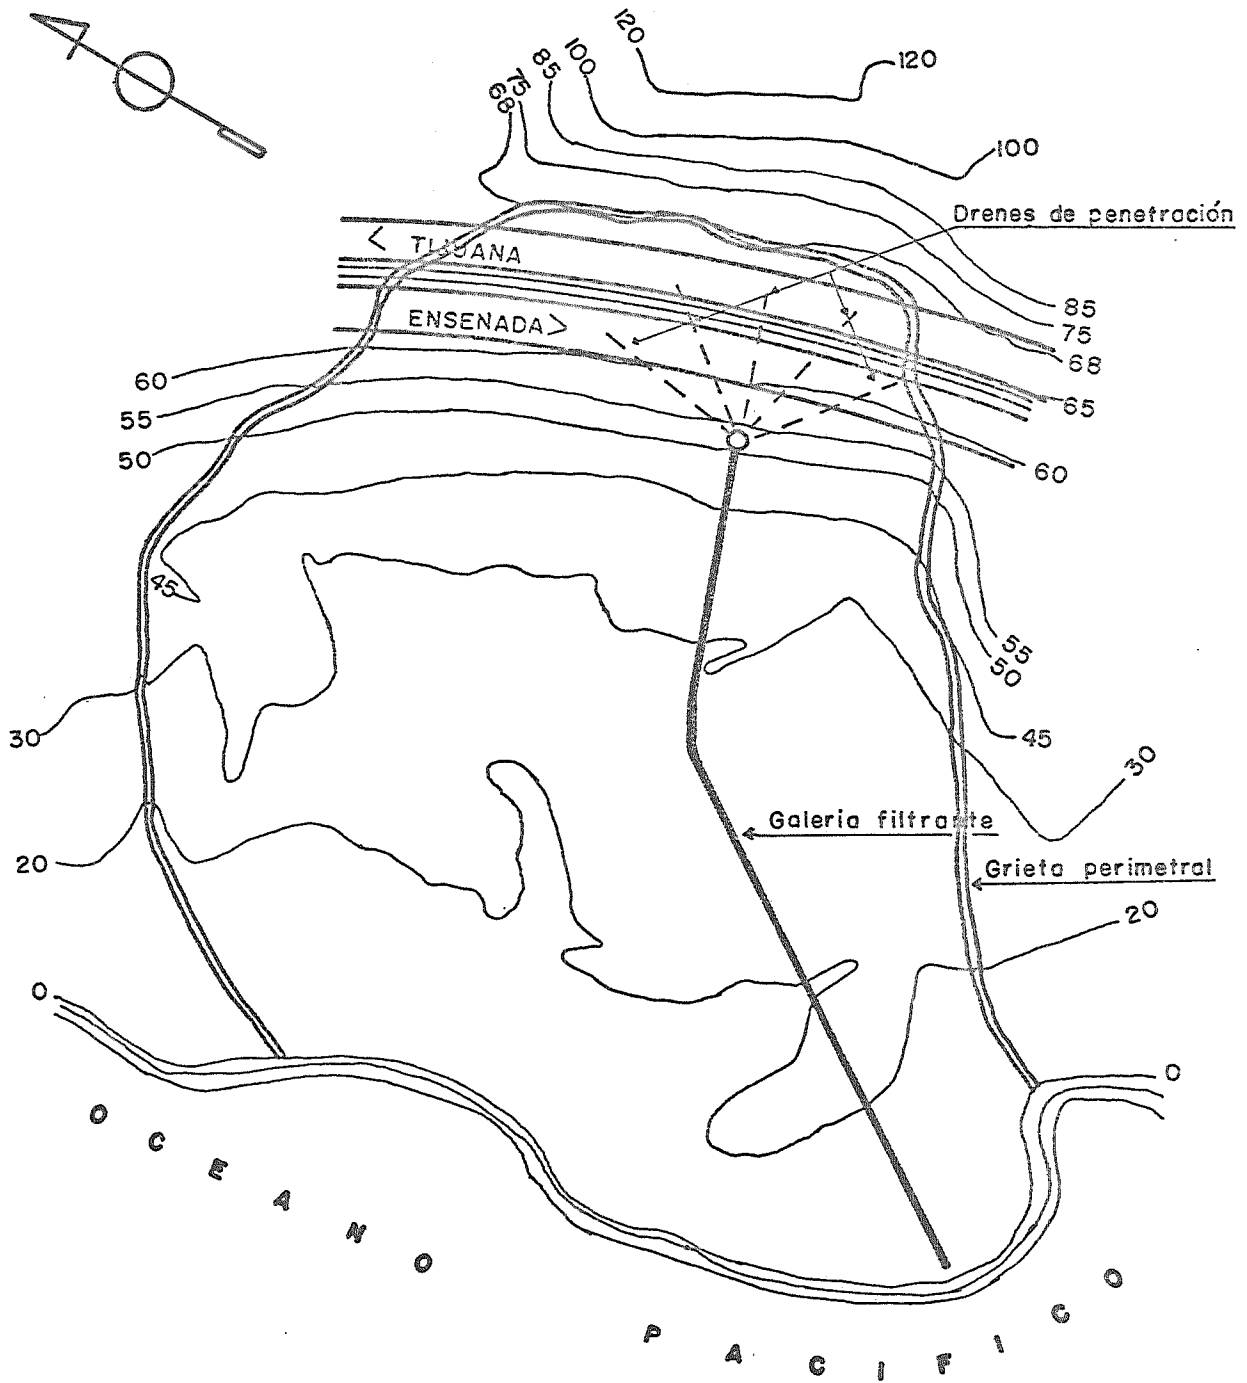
Planta de la galería filtrante construida en el km. 19 + 200 de la autopista Tijuana - Ensenada
